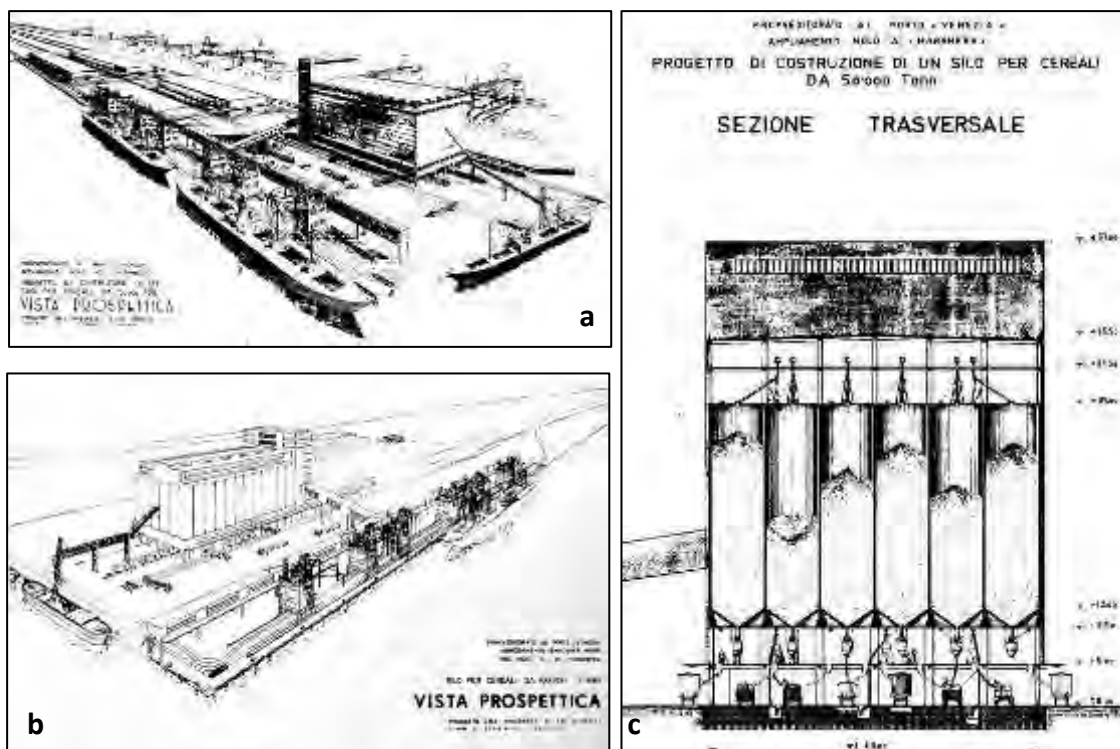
Primo progetto dell’ing. Donelli per silo da 50.000 tonn. (fonte: archivio EZI); 36b. Progetto definitivo del Silo Piemonte, con la capacità di 100.000 tonn. (fonte: archivio Autorità Portuale³⁴); 36.c. sezione trasversale sulle celle di insilamento, con sistemi di caricamento su vagoni o camion (fonte: archivio EZI).
